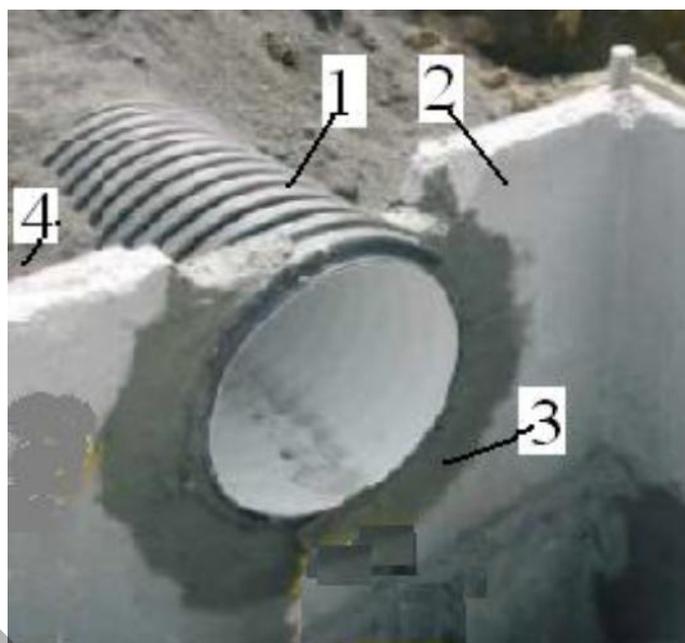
Заделка части ПТ2сМ (ПТ2сГ) при проводе трубопровода на глубинах до 3 м и выше УГВ через стенку бетонного прямоугольного колодца:
